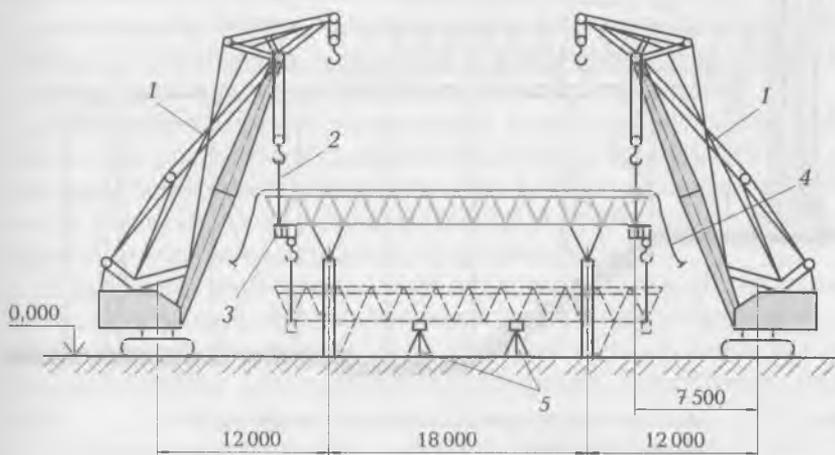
Схема монтажа блока покрытия двумя кранами:
